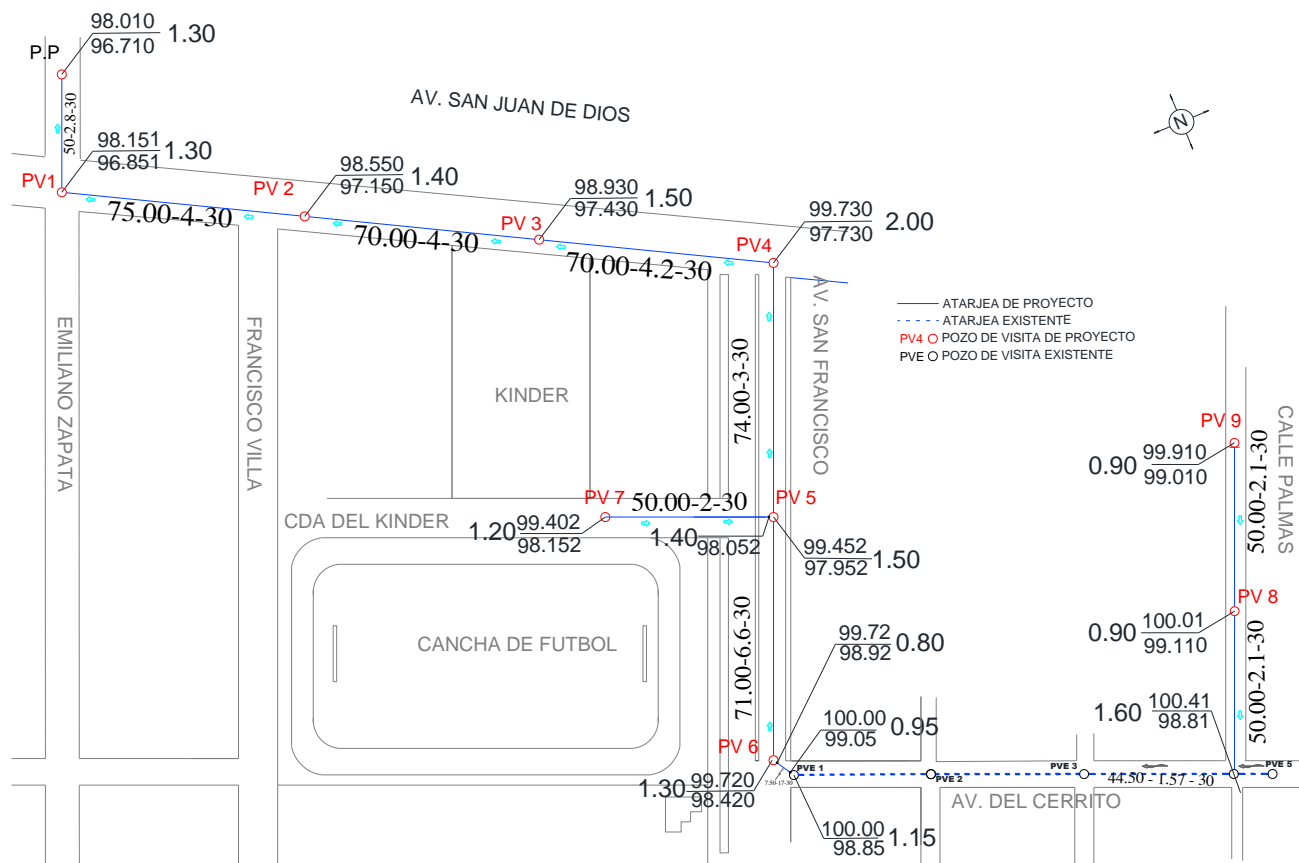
Planta de proyecto de drenaje en av. Del cerrito
